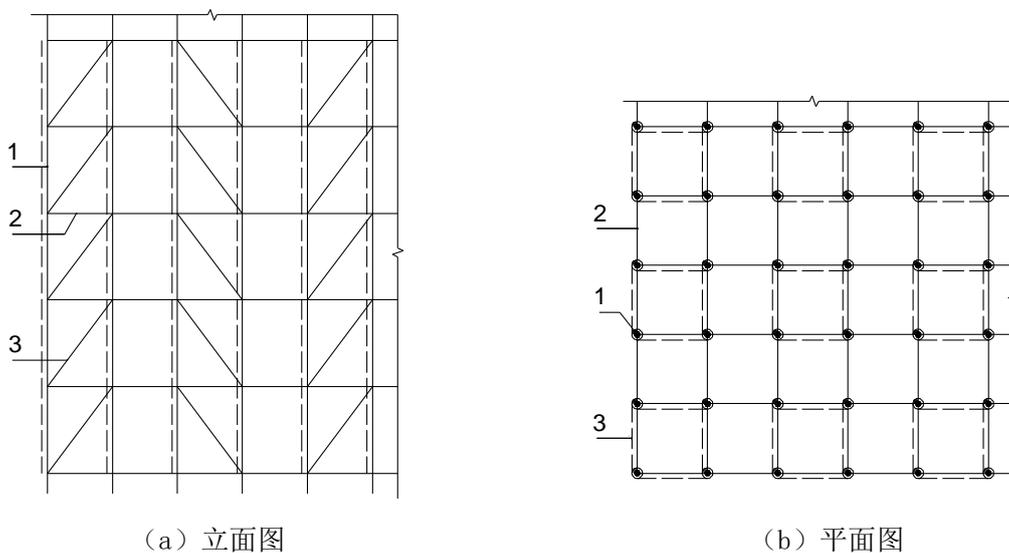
间隔 1 跨形式竖向斜杆布置示意图
